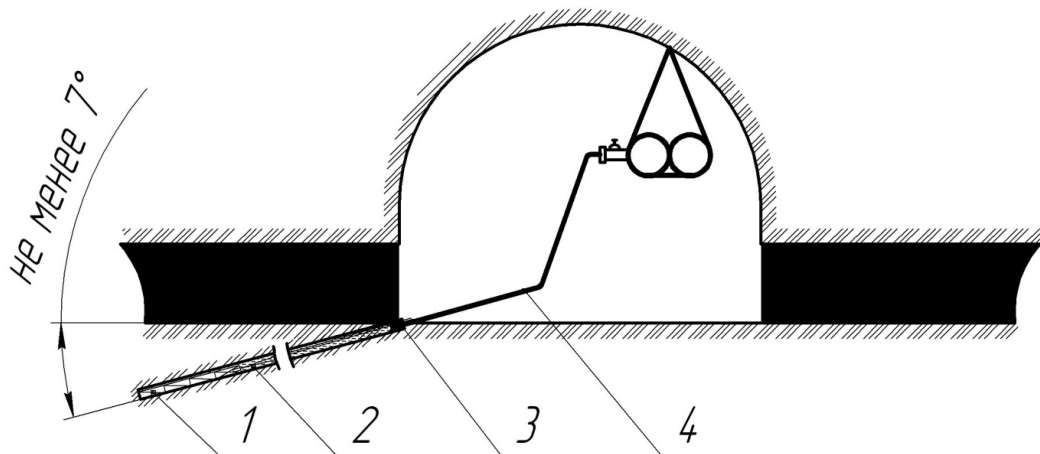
Вариант конструкции наклонного скважинного заряда для взрывания в породах почвы выработки с целью борьбы с пучением: 1 – заряд ВВ; 2 – гидрозабойка; 3 – гидрозатвор; 4 – трубопровод для подачи воды в скважину
